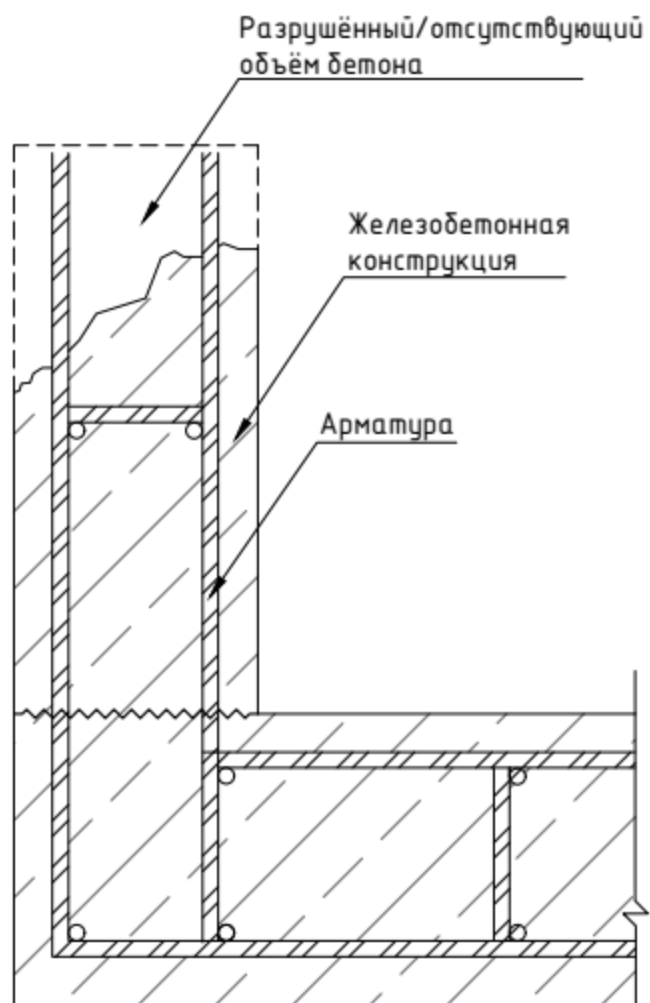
Подготовка конструкции к восстановлению отсутствующего бетона
